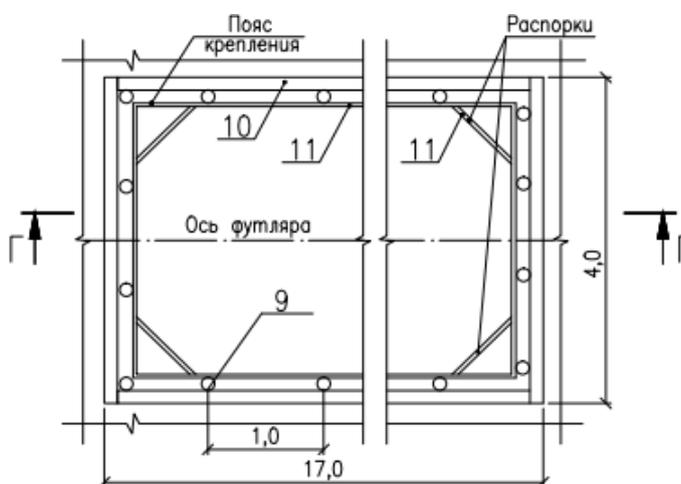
Схема конструкции крепления стенок котлована
